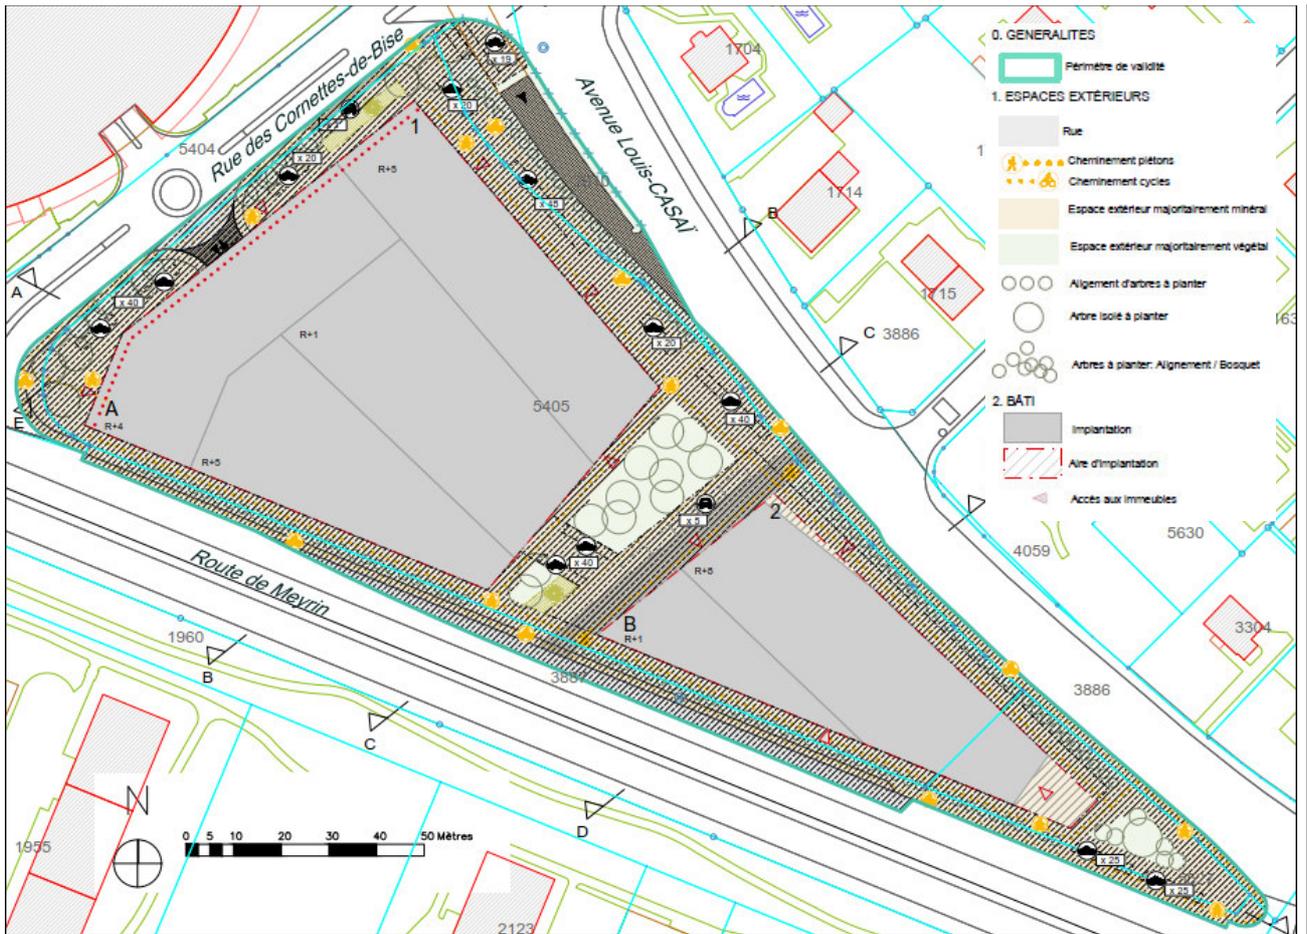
Plan d'aménagement du PLQ Pointe du Bouchet (Burckhardt + Partner SA)
